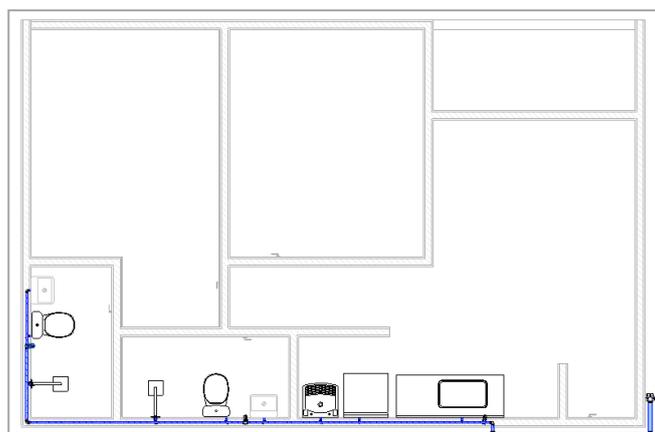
Traçado do sistema ramificado em planta para o PVC. (Fonte: O Autor, 2022)
